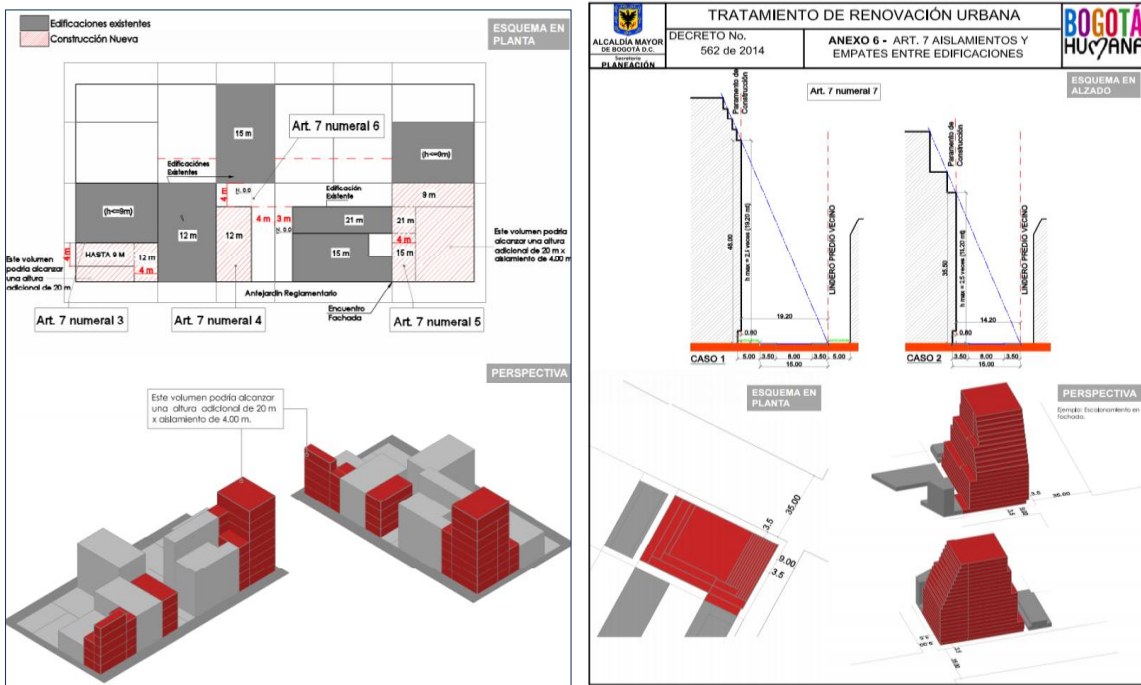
Detalle de Aislamientos Decreto 562 de 2014 - Fuente: SDP
